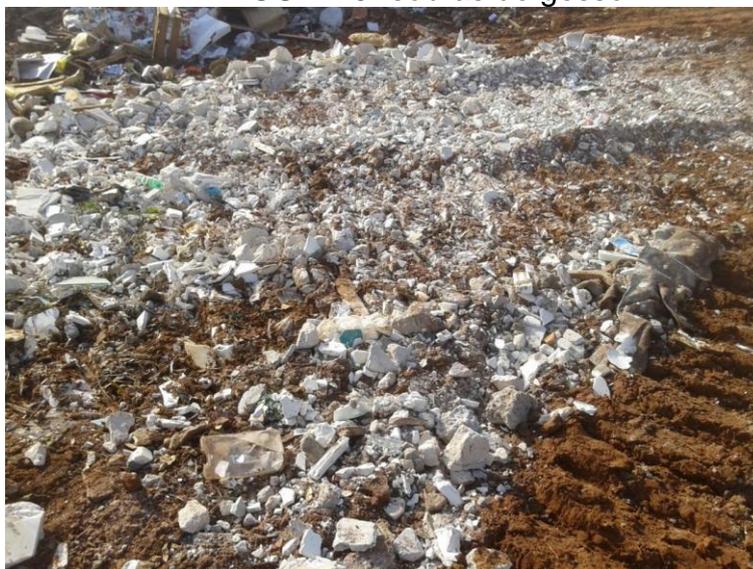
Descarregamento de sobras de concreto e outros resíduos
